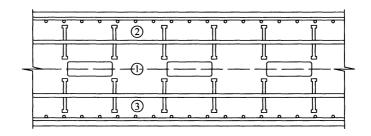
双层钢板混凝土剪力墙混凝土浇筑示意 (浇筑顺序: ①→②→③)
